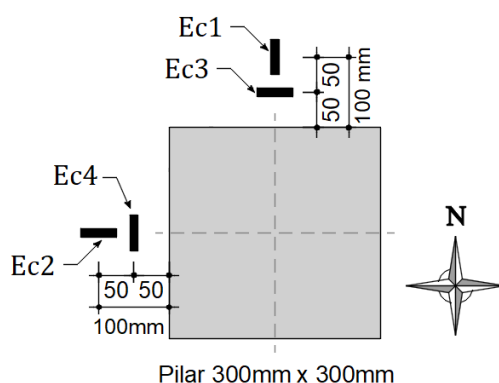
Posição dos extensômetros na região inferior da laje (unidades em mm)
